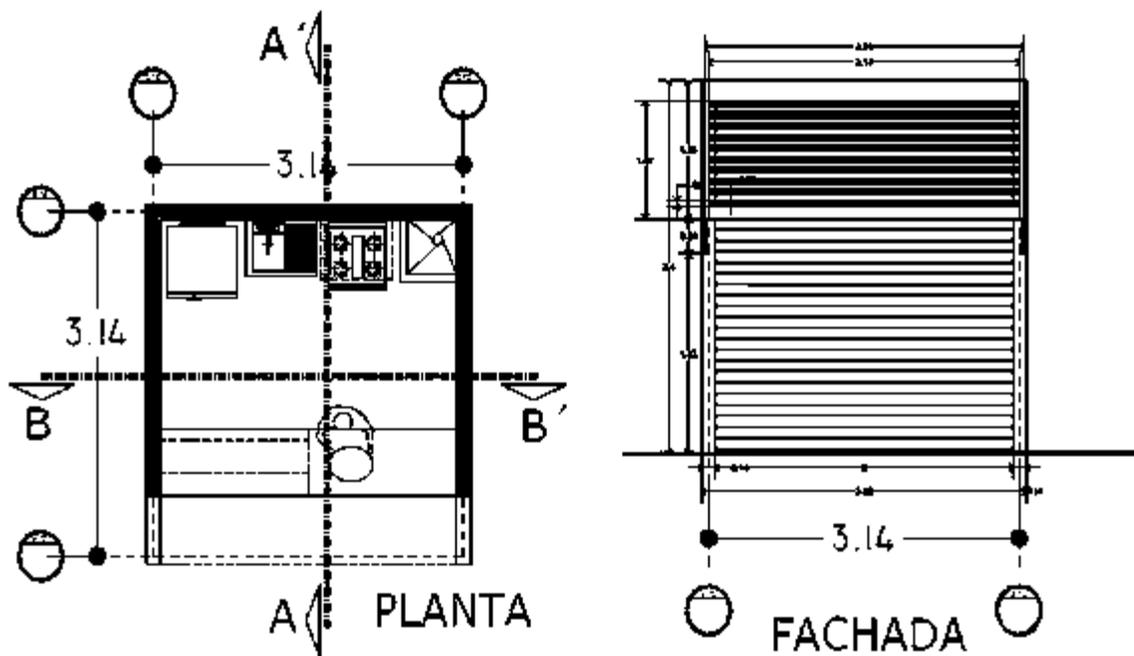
Estudio de Áreas De locales De Tortillería y Panadería
